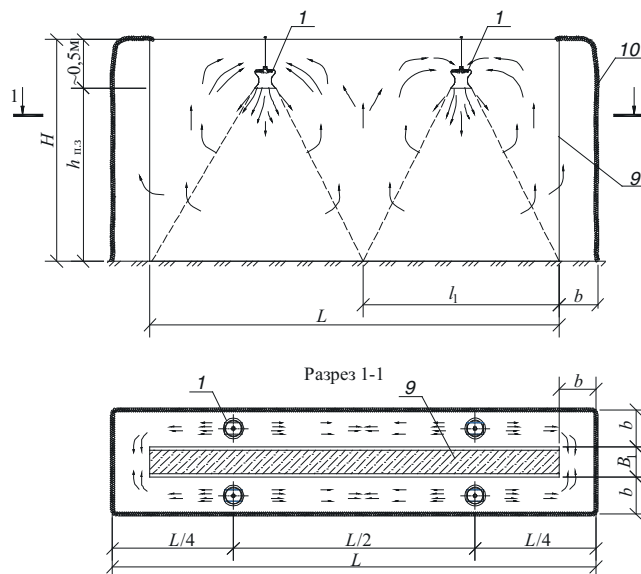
Схема размещения УВКП для прогрева монолитной железобетонной стены. Обозначения см. на рис. 2
